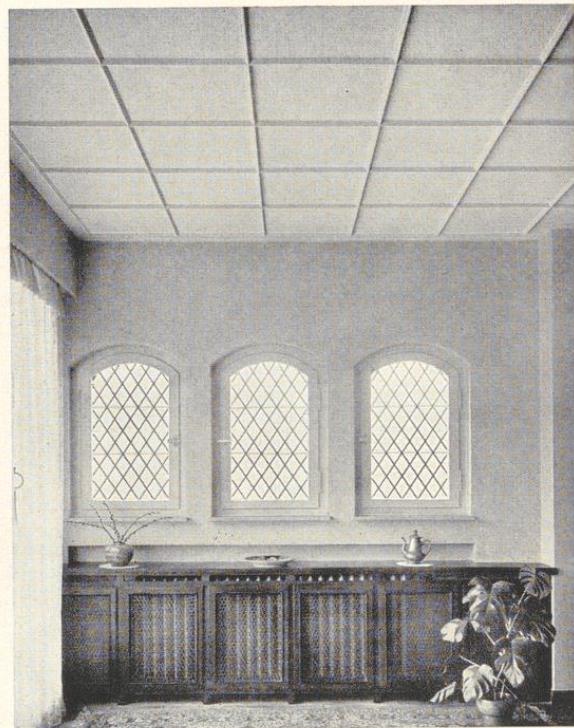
Stuckdecke in der Vorhalle eines Landhauses. Ausführung Stuckgeschäft J. Odenthal, Düsseldorf-Gerresheim
